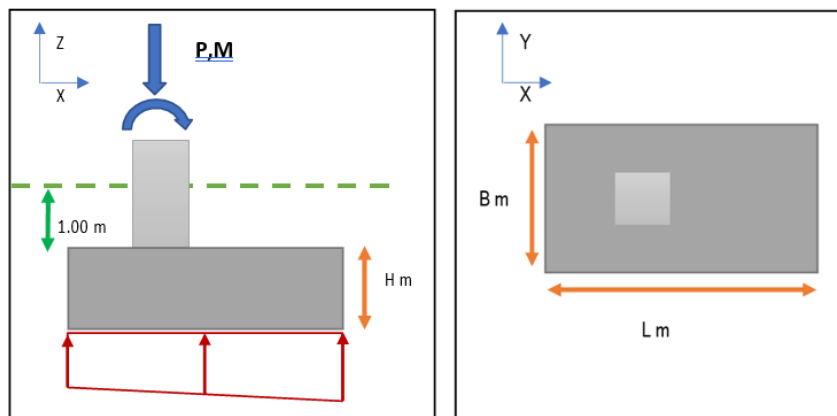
Sección de la Zapata. Fuente: Solpesa SAC. (2023).
